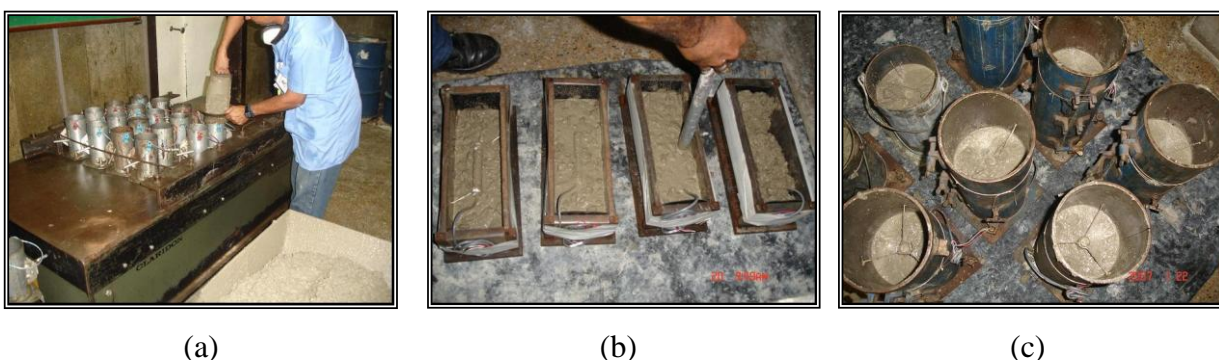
Moldagem de corpos de prova: a) formas cilíndricas; b) ensaios de retração, e c) ensaios de fluência.
